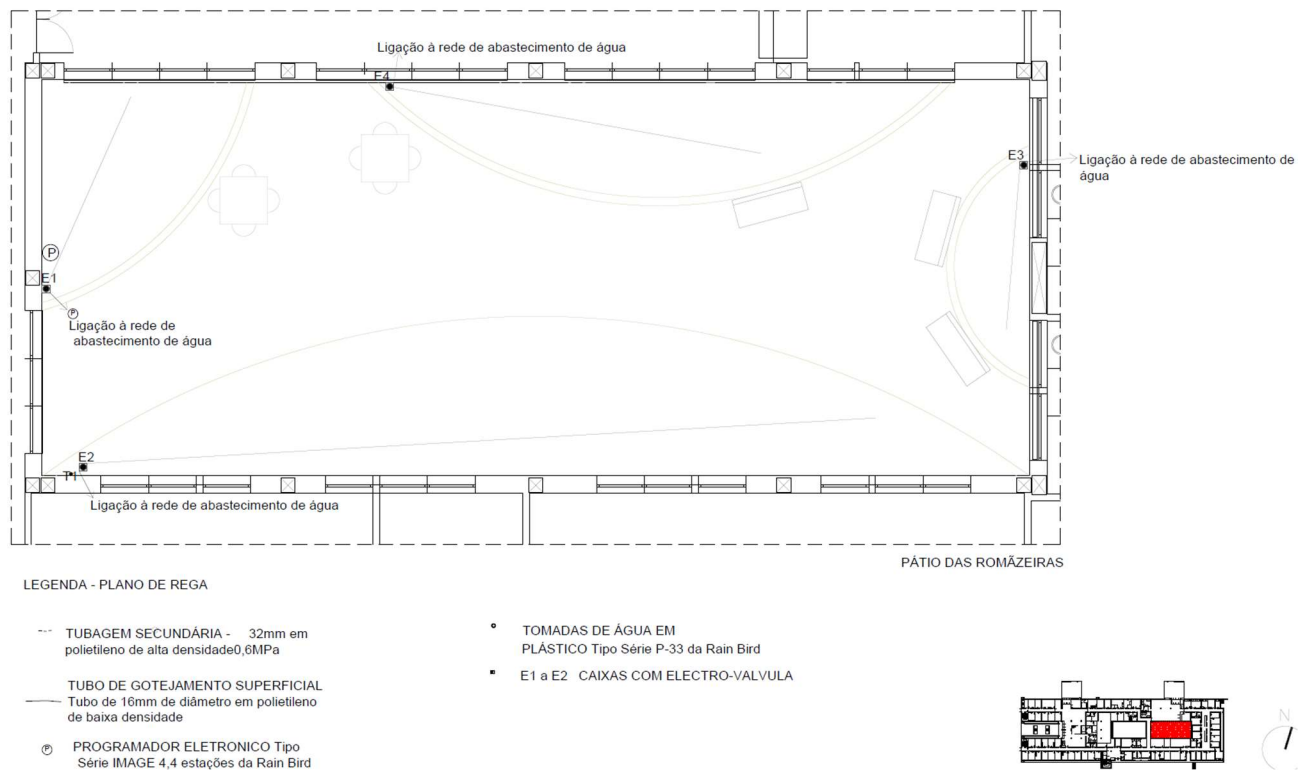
Pátio das Romãzeiras: plano de planimetria.
